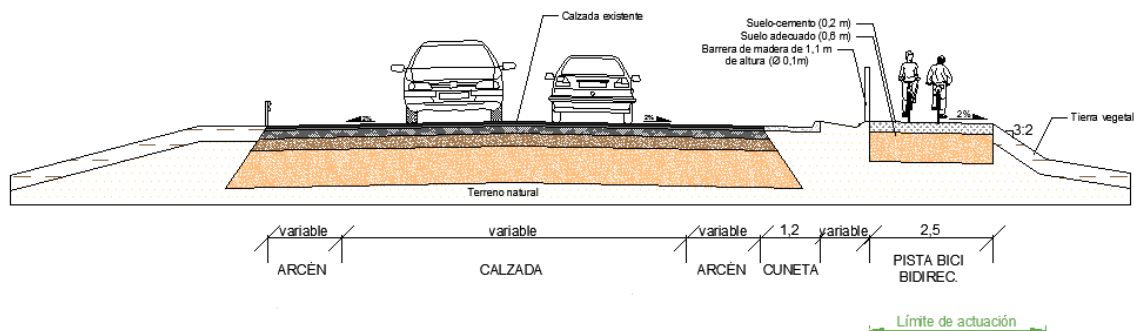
Sección tipo ST-5.2: Tramo 5. Pista bici bidireccional. Sección terraplén.
